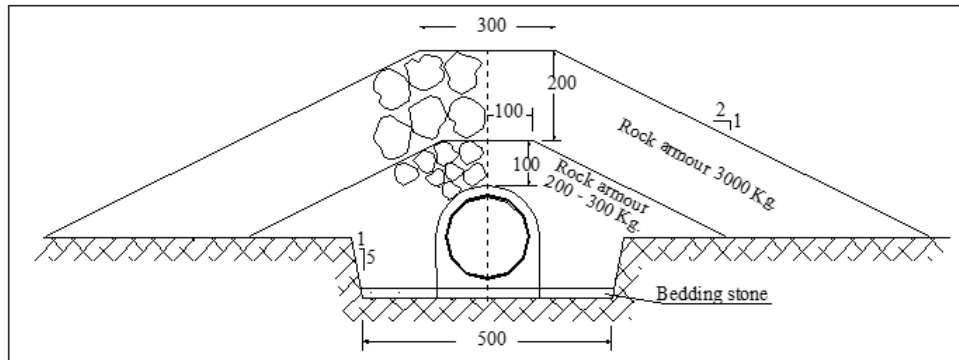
Perfil transversal de uma solução de proteção estrutural de taludes sobre vala escavada em fundo rochoso. *Alvarez et al., 2002
